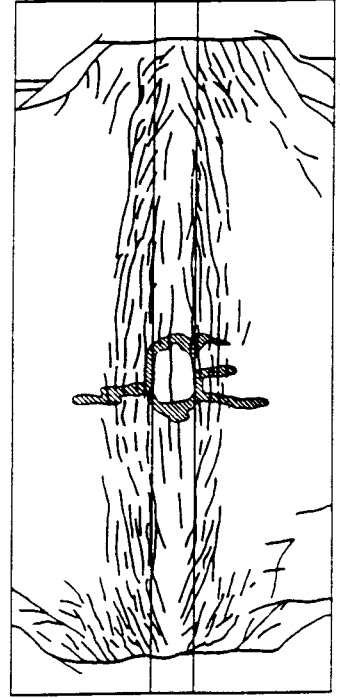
Beobachtete Rißbilder und ausgefallene Betonelemente an der Plattenoberseite des Versuchskörpers S2
